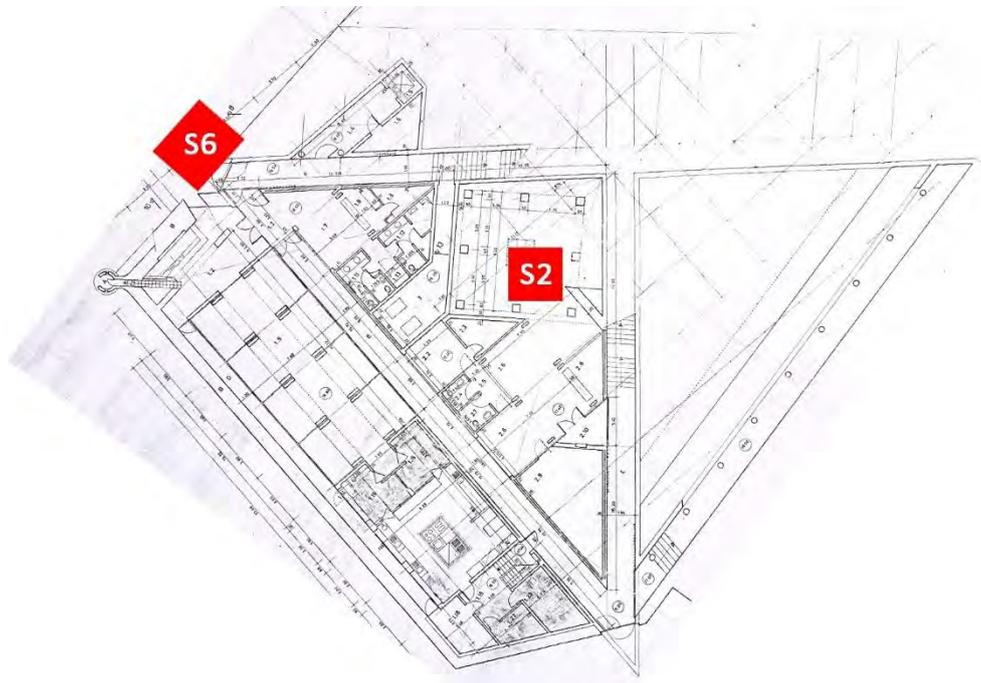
Localização das sondagens 2 e 6 sobre a planta do piso 0.
